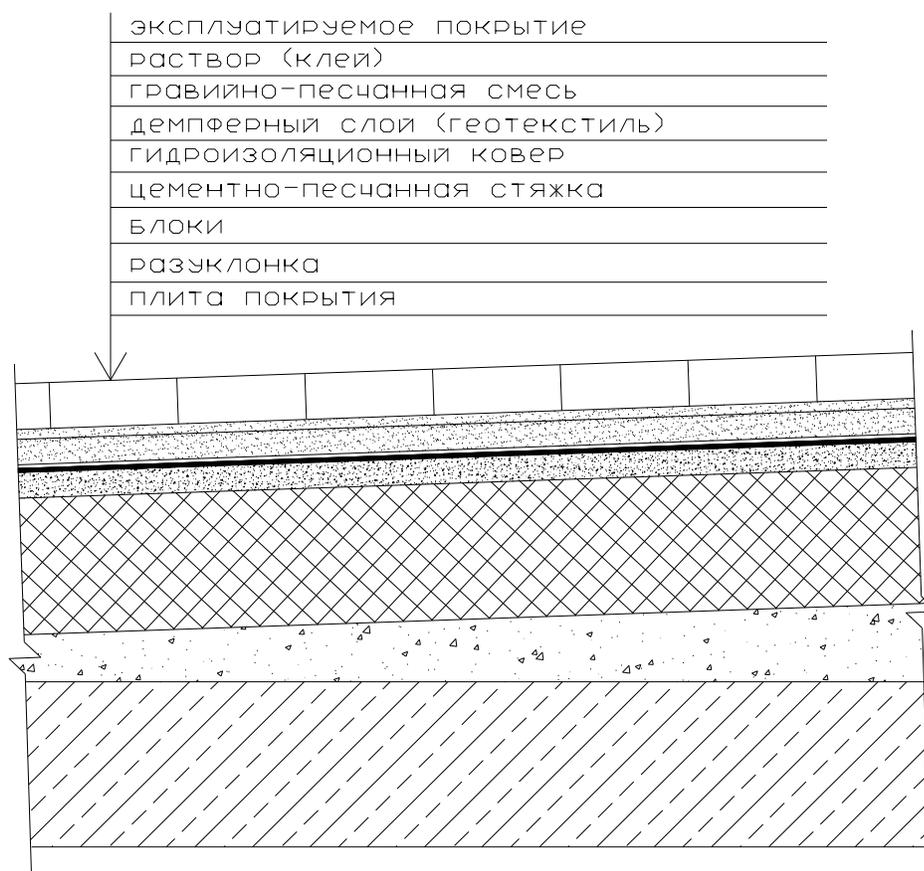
Тепловая изоляция в совмещенной эксплуатируемой кровле
